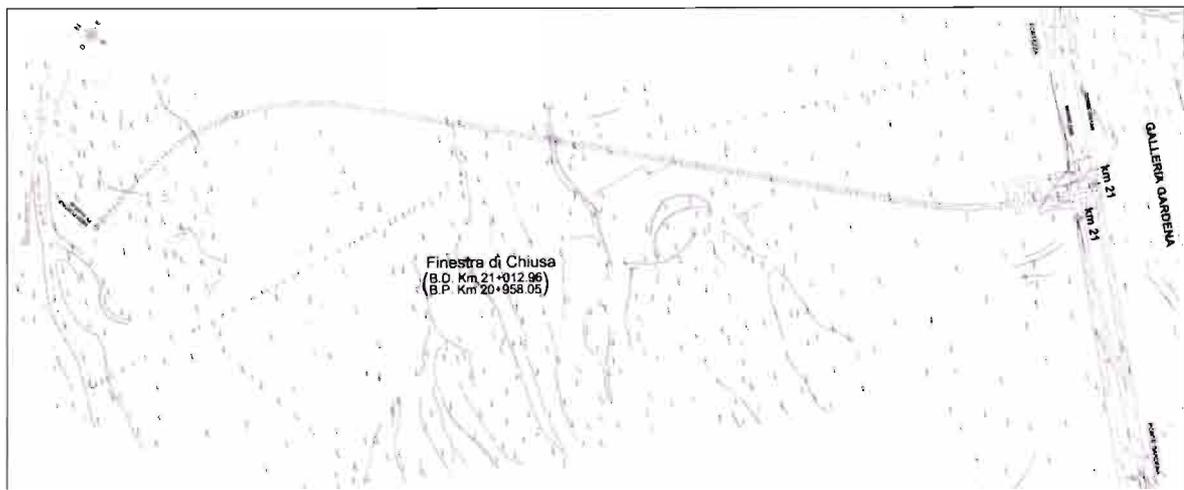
Stralcio planimetrico Discenderia di Chiusa
